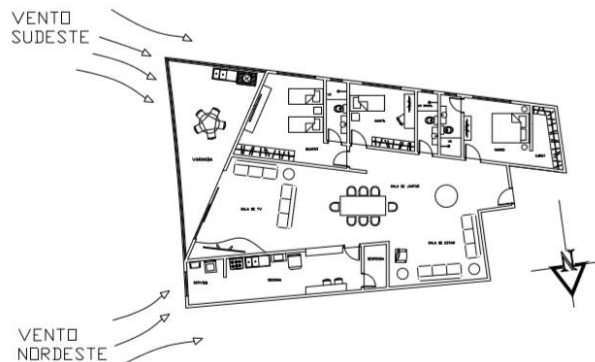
Planta baixa do apartamento tipo 2. Fonte: elaborado pelos autores.
